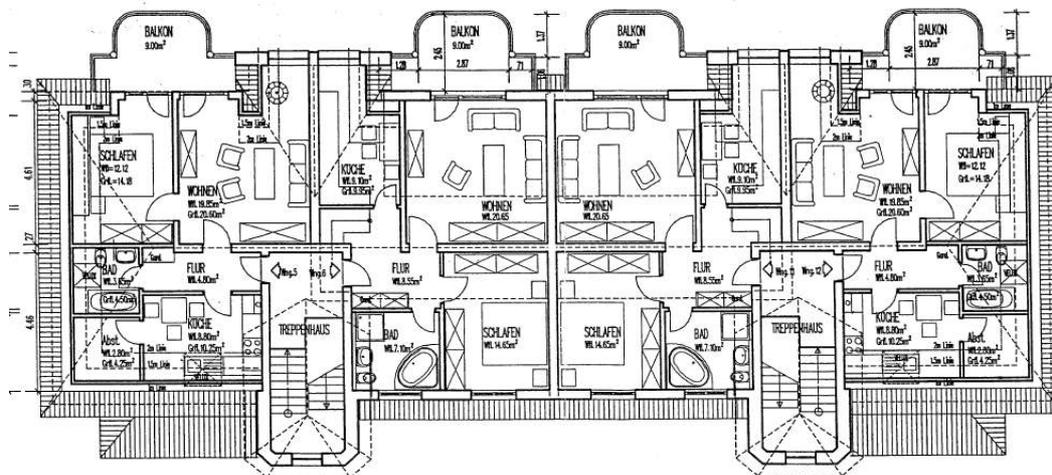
Grundriss DG, Planausschnitt o.M.
